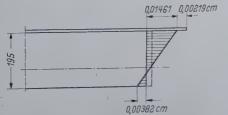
Zur Ermittlung der Schubkraft zwischen Stauwandund Rückenblech
